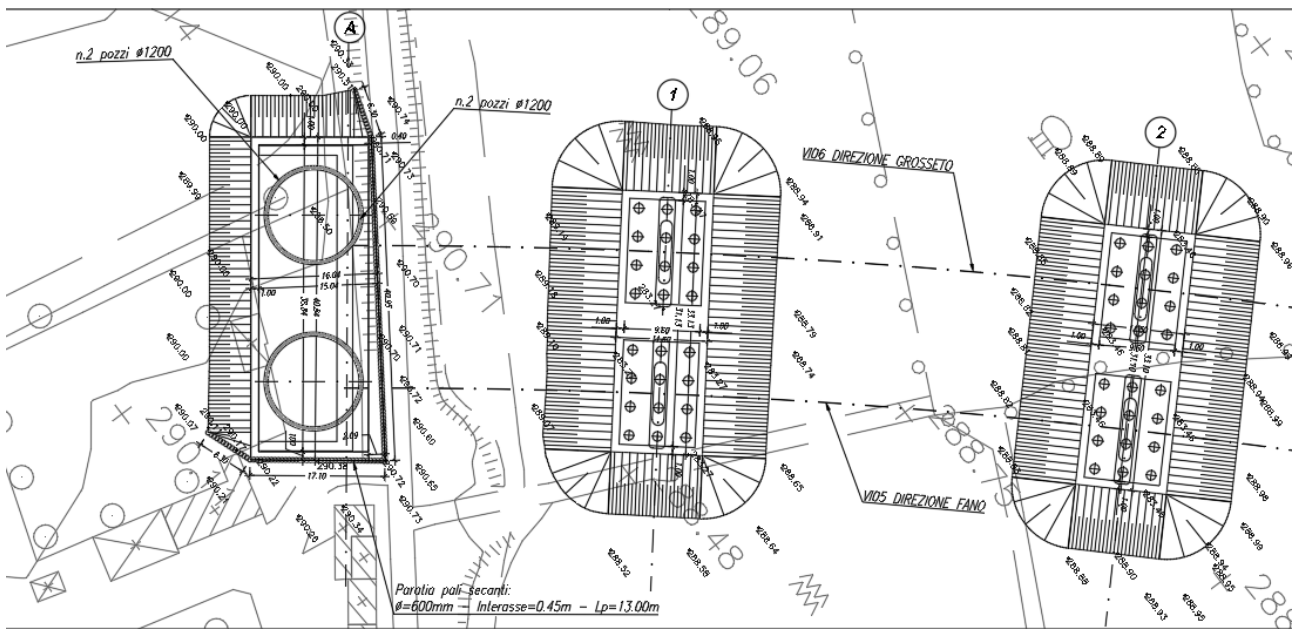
Pianta fondazioni e scavi in prossimità dell'alveo
